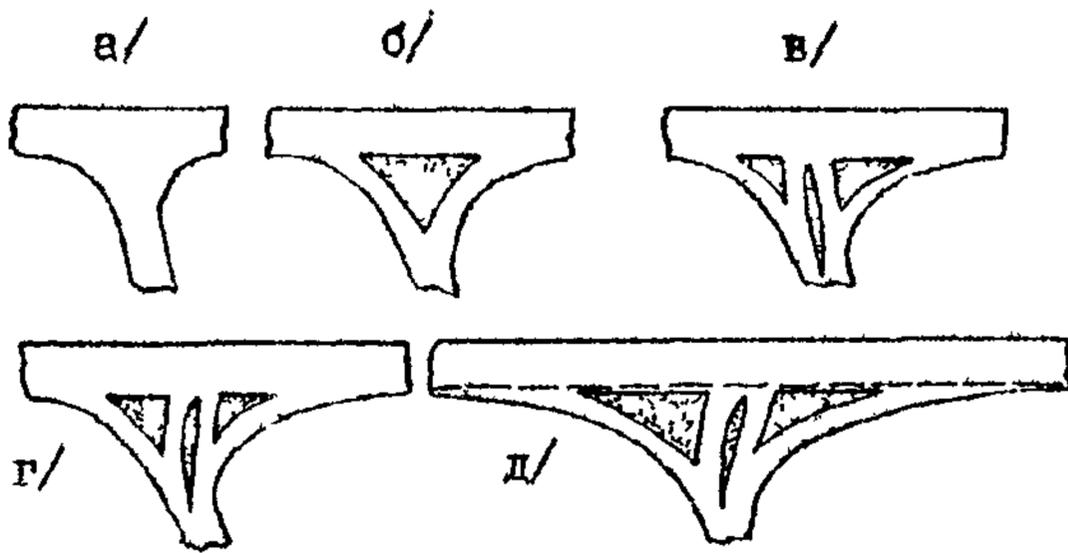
Пример разработки вариантов планировочного решения пересечения: а - простое необорудованное; б - с треугольным островком на второстепенной дороге; в - с канализированием движения на второстепенной дороге; г - то же с изменением угла пересечения потоков; д - то же с переходно-скоростными полосами.
